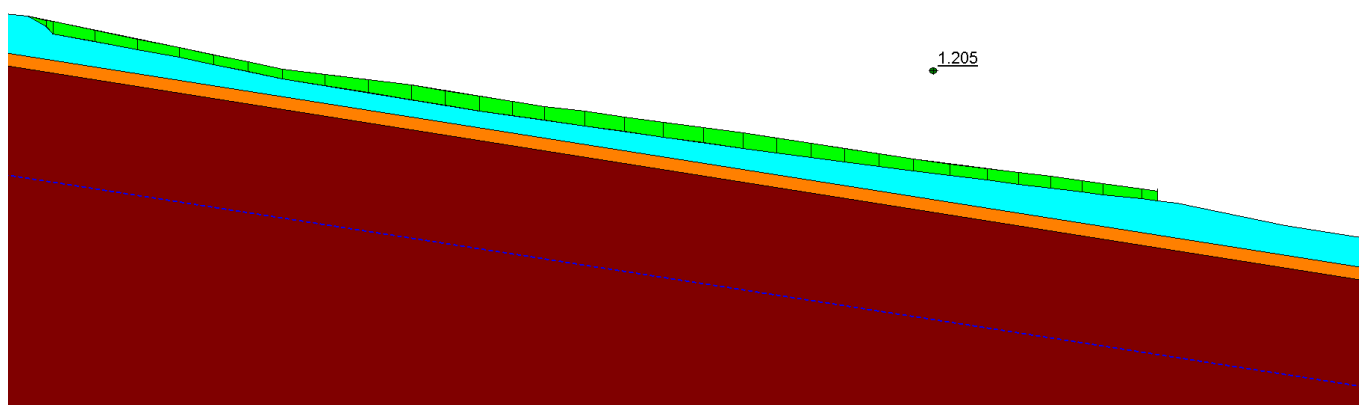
Sezione 1 – Valutazione forza stabilizzante
